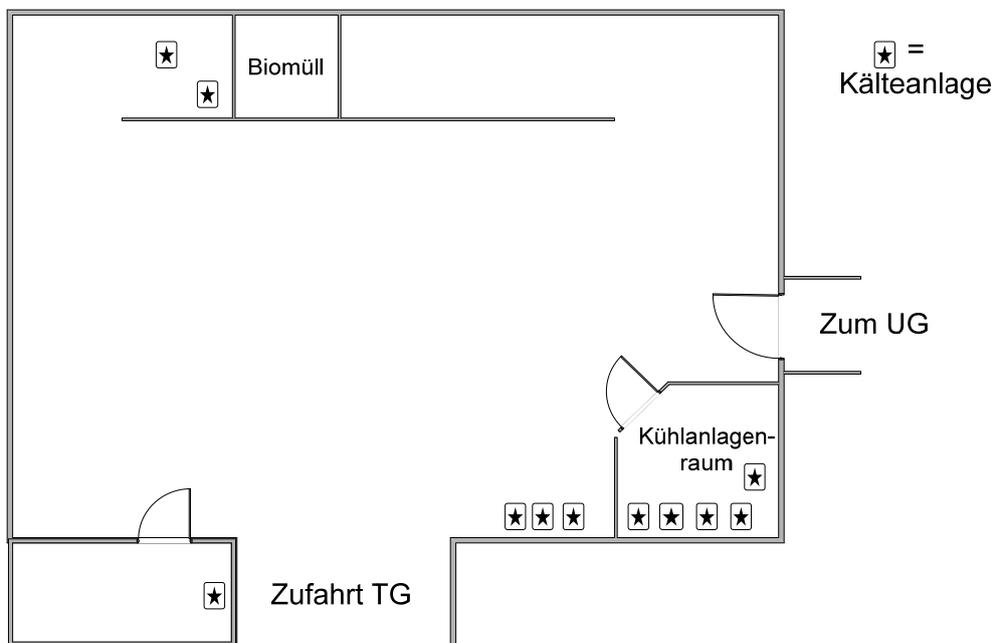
Grundrisssskizze Tiefgarage
